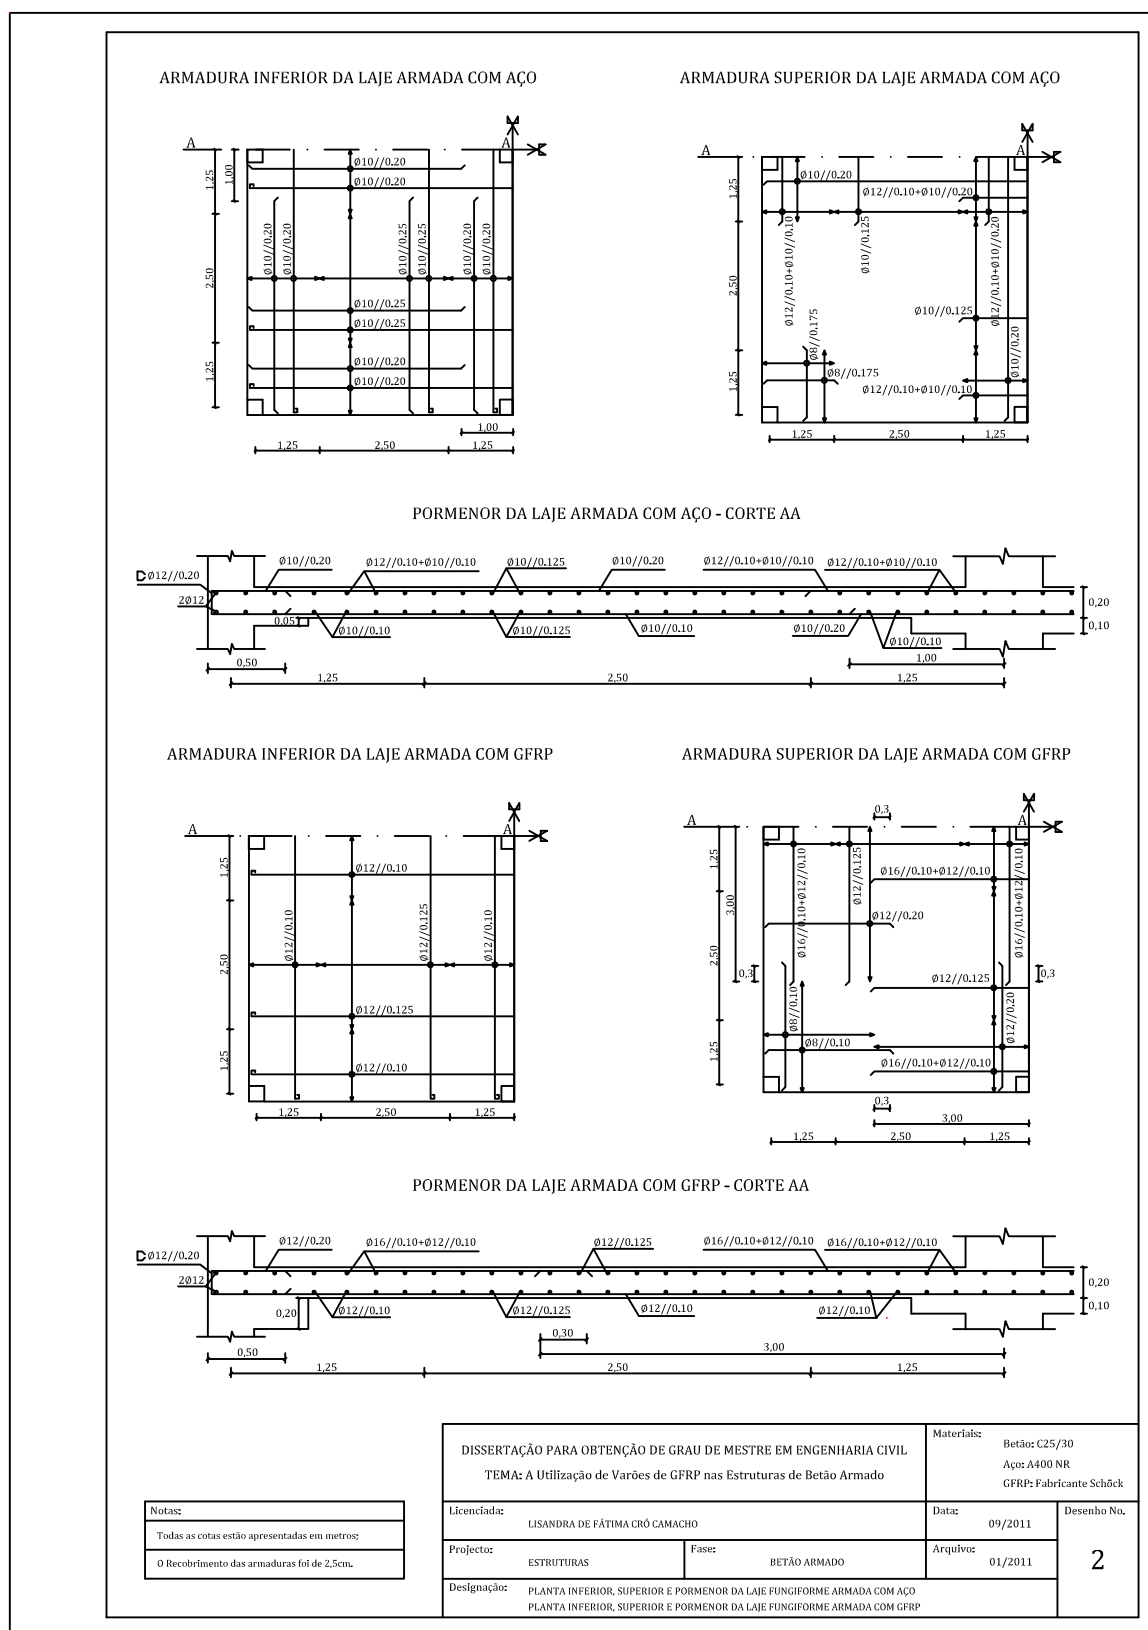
Desenhos de betão armado da laje fungiforme.
